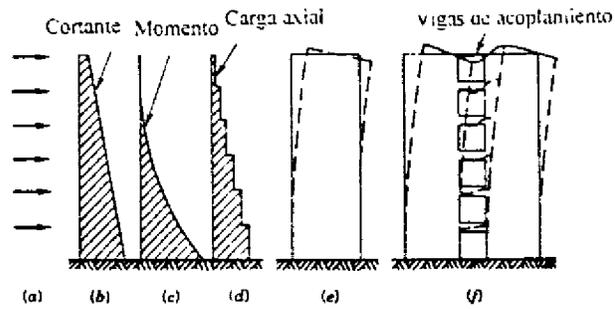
Variación de la fuerza cortante, momento y carga axial en un muro estructural aislado
